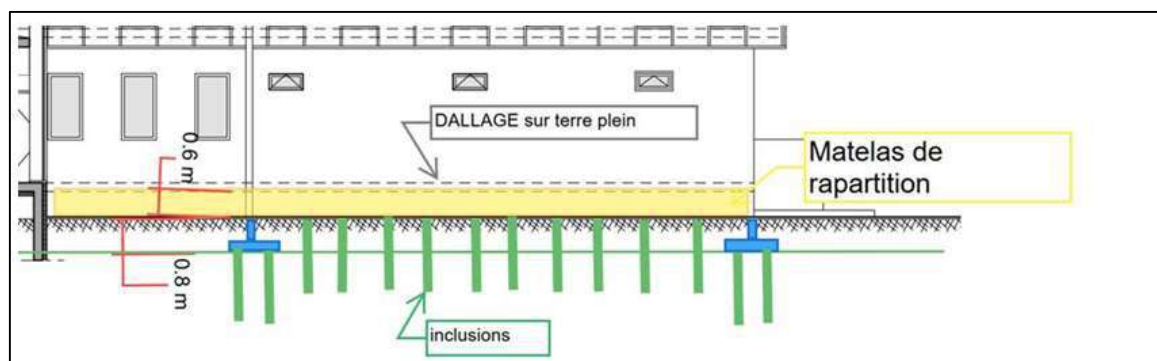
Plan en coupe schématique du projet d'extension du bâtiment 0203.
